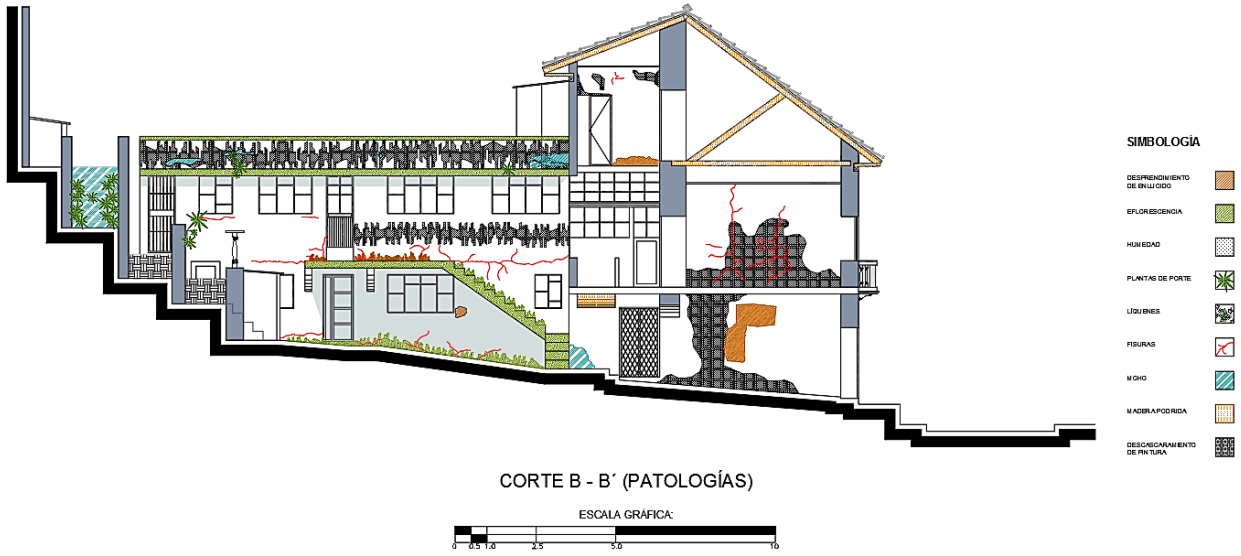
Patologías Corte B – B' • Fuente: Ilustración Propia
